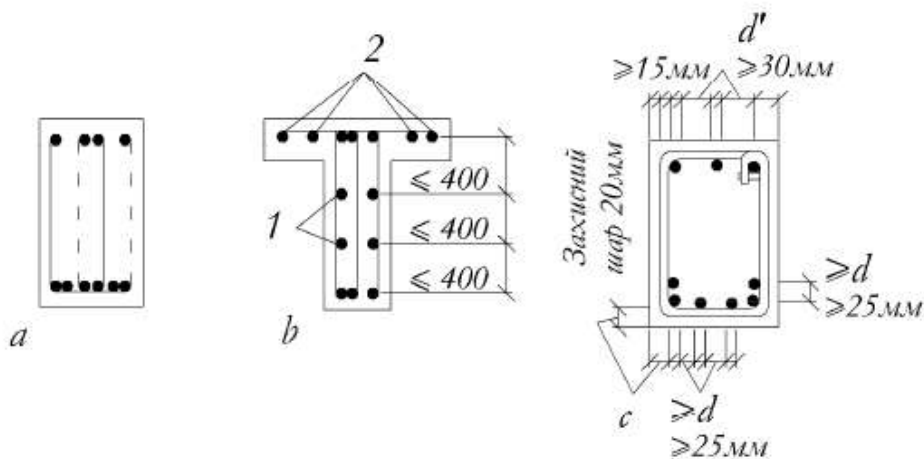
Поперечний переріз балок, армованими зварними та в'язаними каркасами: *a* - чотирьохвіткові хомути в'язаних каркасів; *b* - армування балок таврового перерізу; *c* - відстань в світлі між поздовжніми стержнями; 1 - арматура 10-12мм по боках граней балок; 2 - поздовжні стержні зварної сітки для армування полички таврового перерізу
